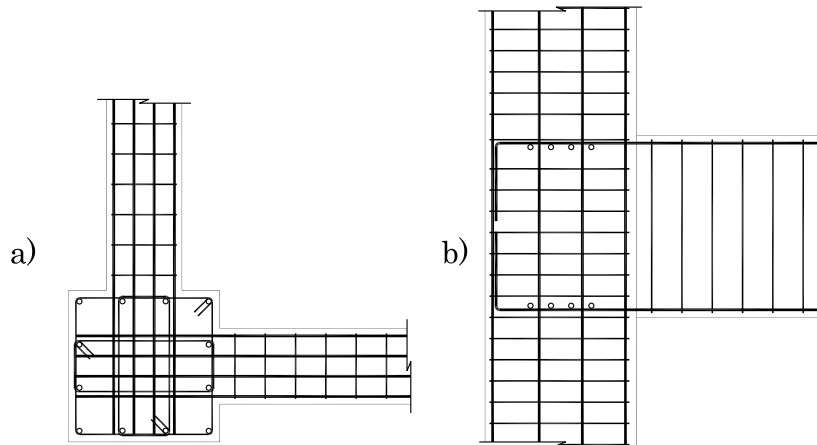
Detalle en a) planta y b) alzado del armado típico de una junta exterior viga-columna
